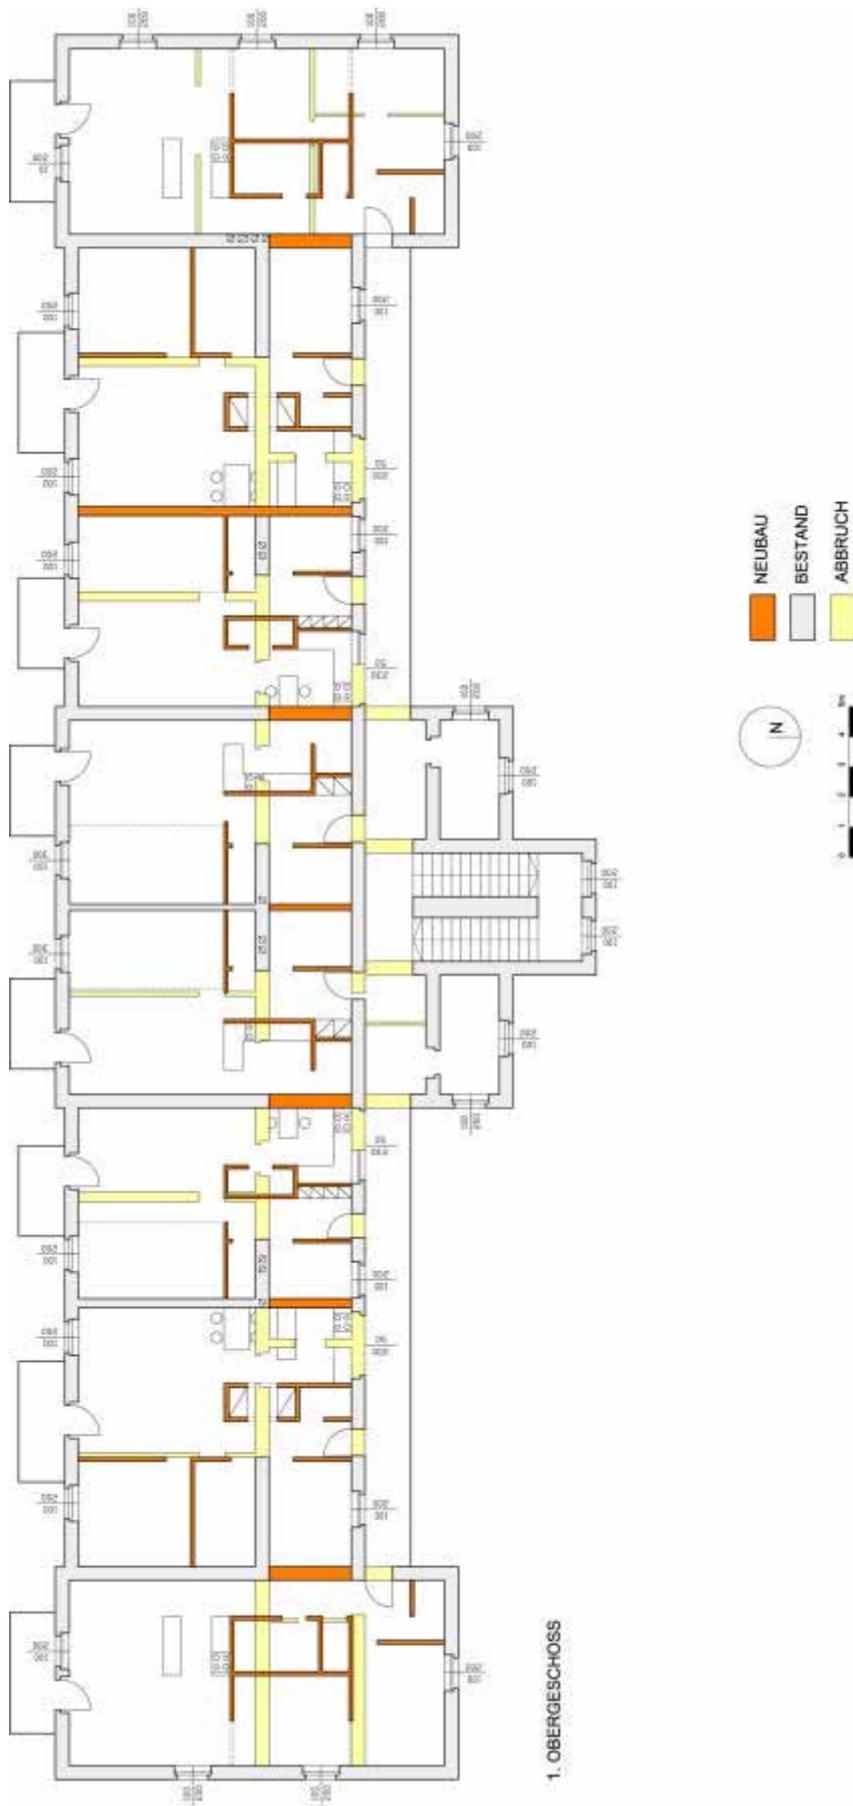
Grundriss 1.Obergeschoss
